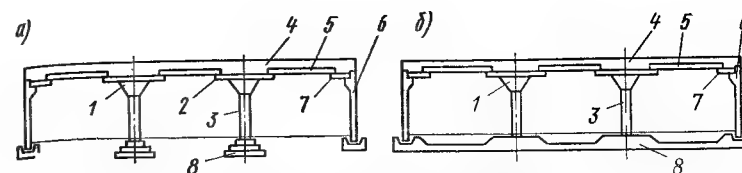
Конструктивные разрезы убежищ, выполненные с применением железобетонных элементов У-01-02/80
